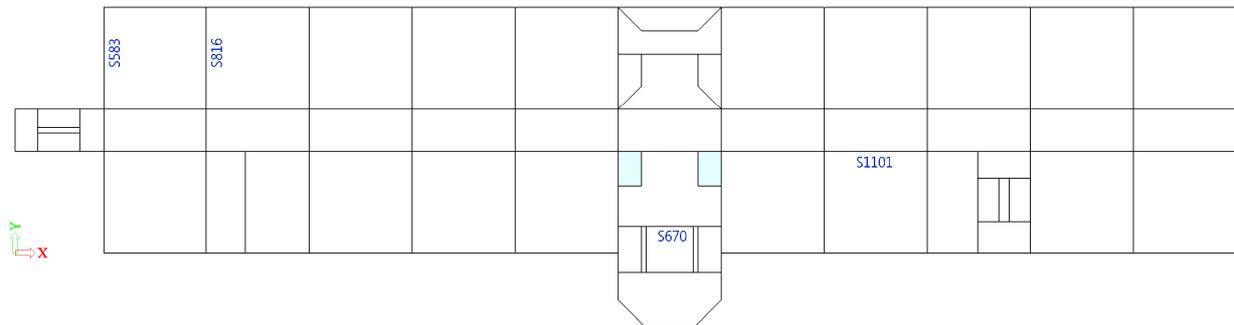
Grundriss - Position maßgebende Rippen
